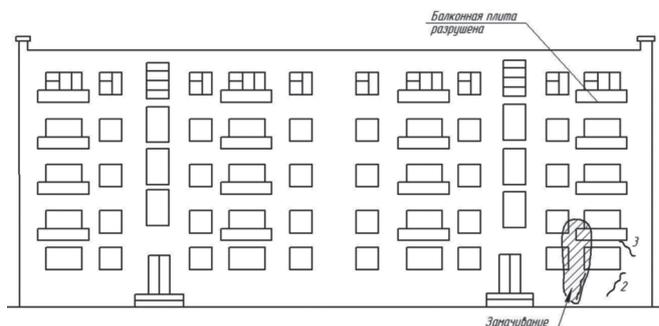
Дом 48. Трещины стены главного фасада
